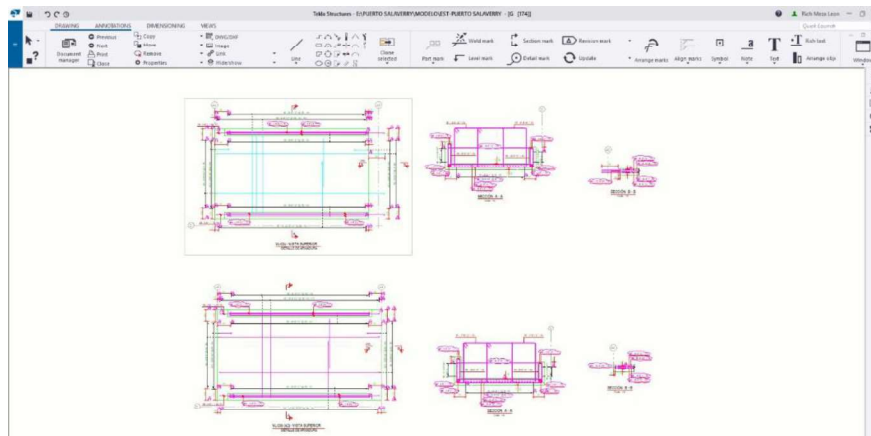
Plano de detalle desde modelo. Elaboración propia
